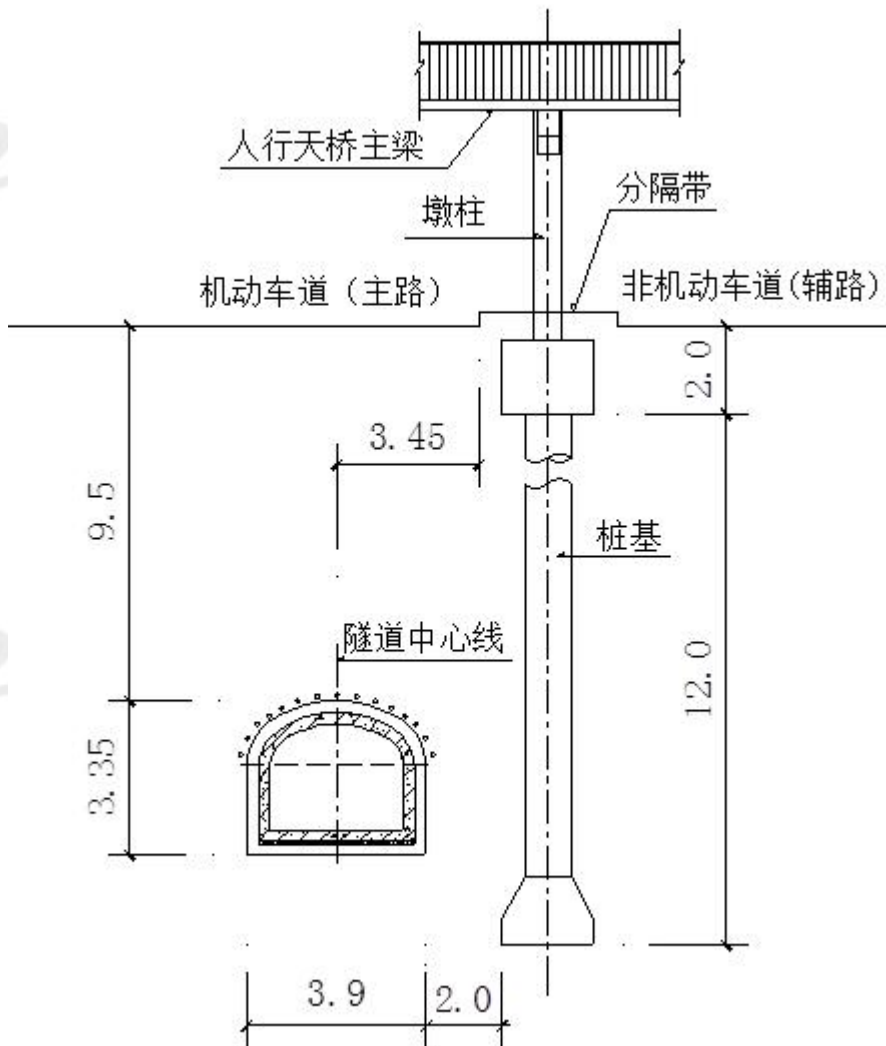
下穿人行天桥隧道横断面示意图 (单位: m)
